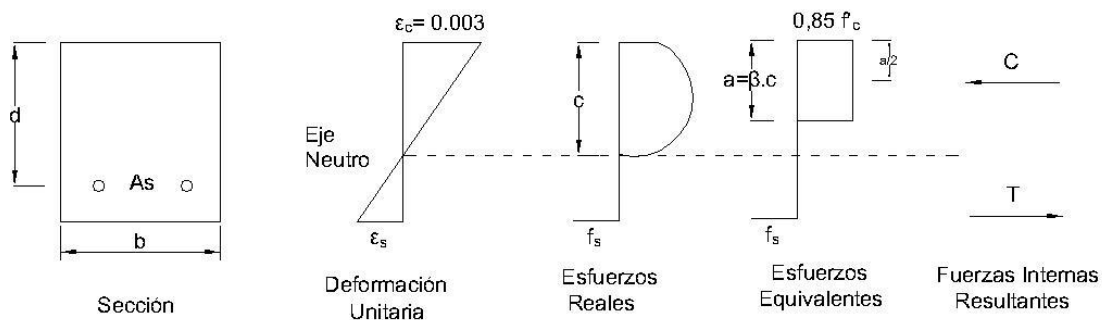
Sección de concreto simplemente Reforzada cuando se alcanza la resistencia a Flexión. Fuente:
